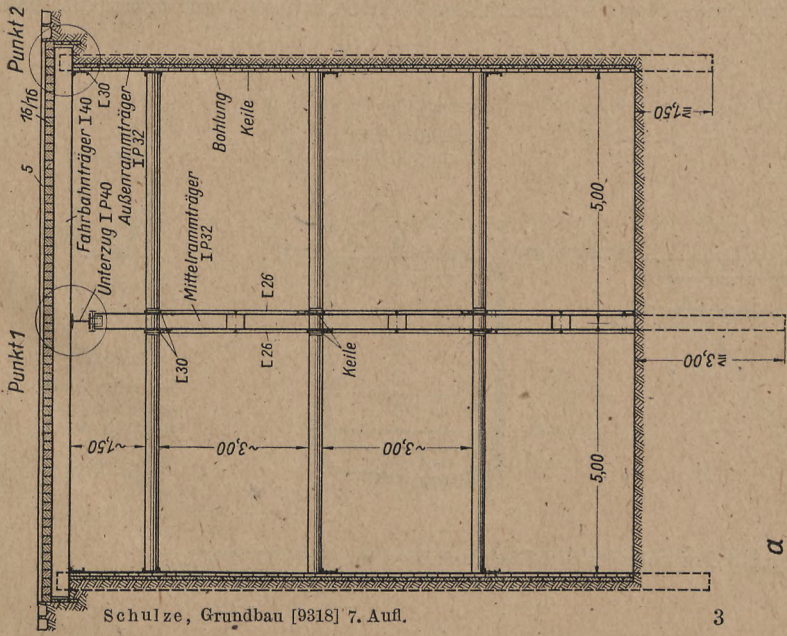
Baugrubenaussteifung für einen Untergrundbahntunnel nach der Berliner Bauweise
